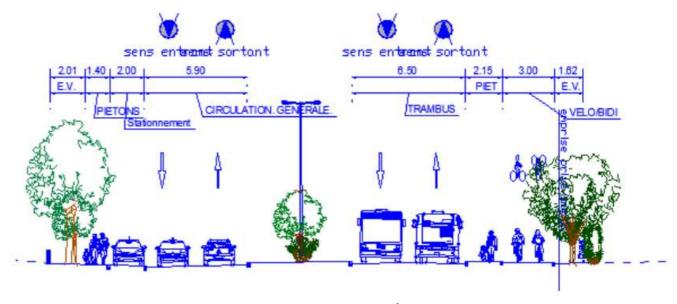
Profil en travers de la voirie (Source : Études préalables de la T1)
